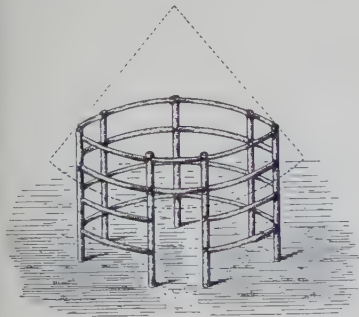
Wandgerüst und Grundriss der üblichen Kegelhütte.
